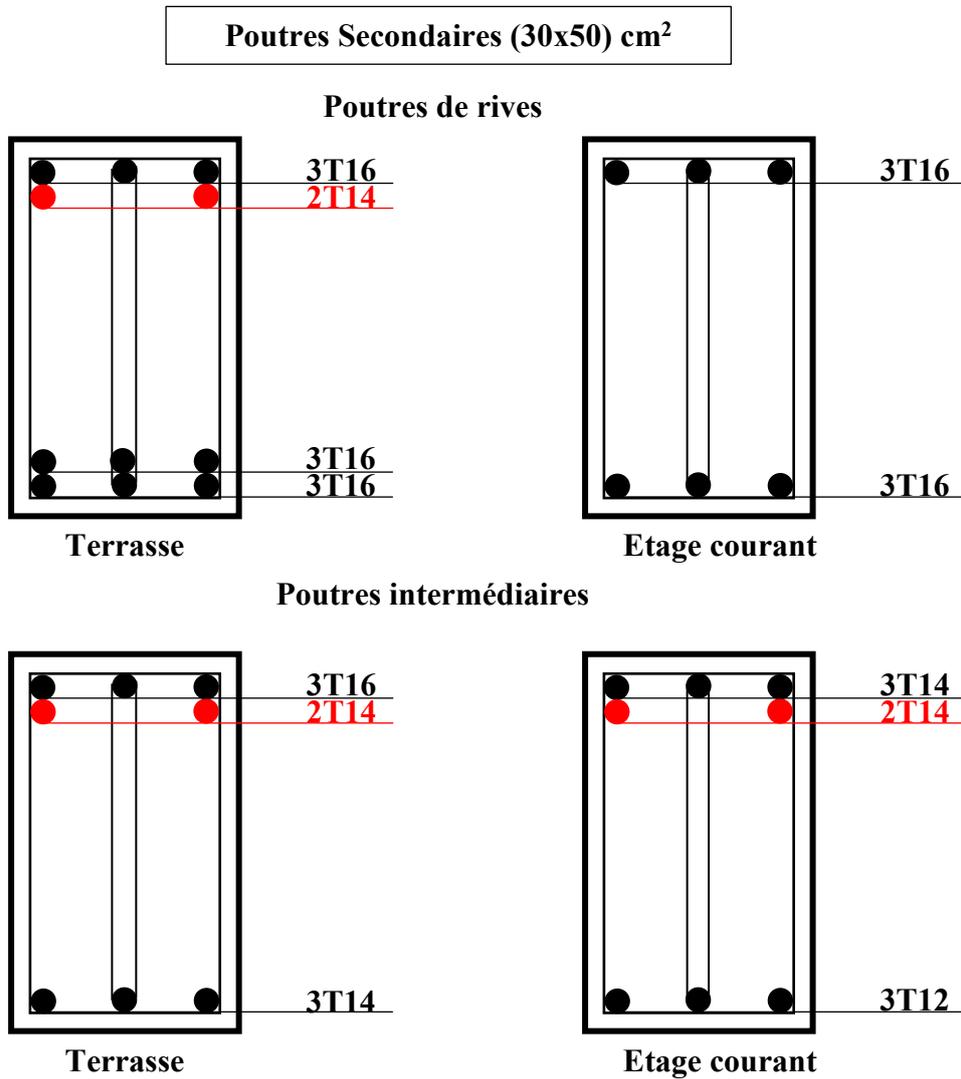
Dessin de ferrailage des sections des poutres Secondaires
